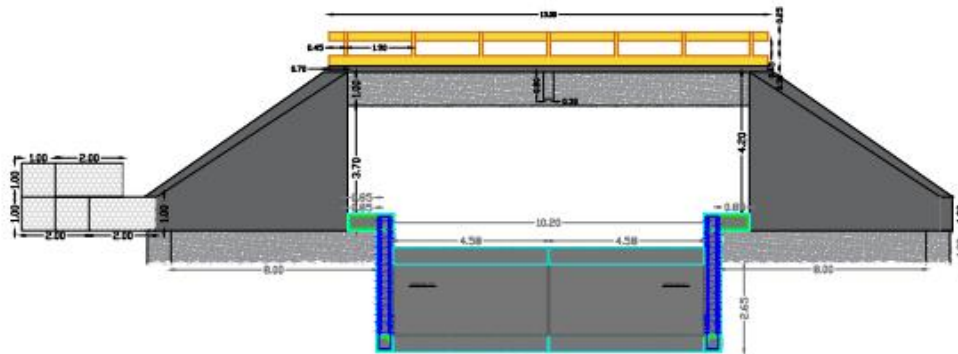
Esquema de obra Hidráulica Propuesta (recalce estructural de los estribos)
